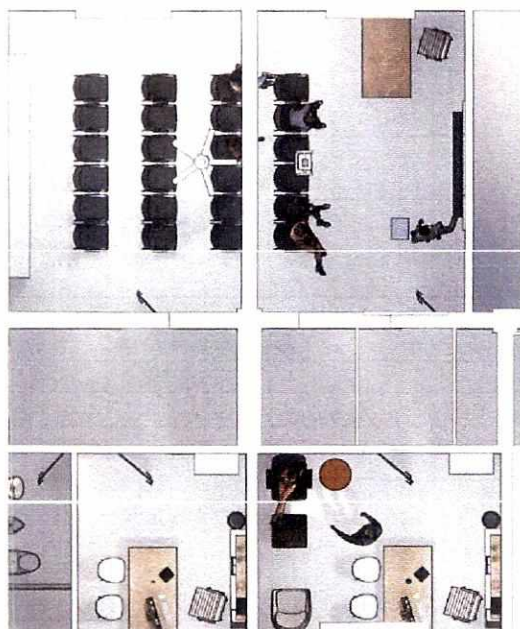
VISTA AÉREA EN 3D DEL ÁREA DE LA INTERVENCIÓN PABELLÓN 1 (LADO A)
